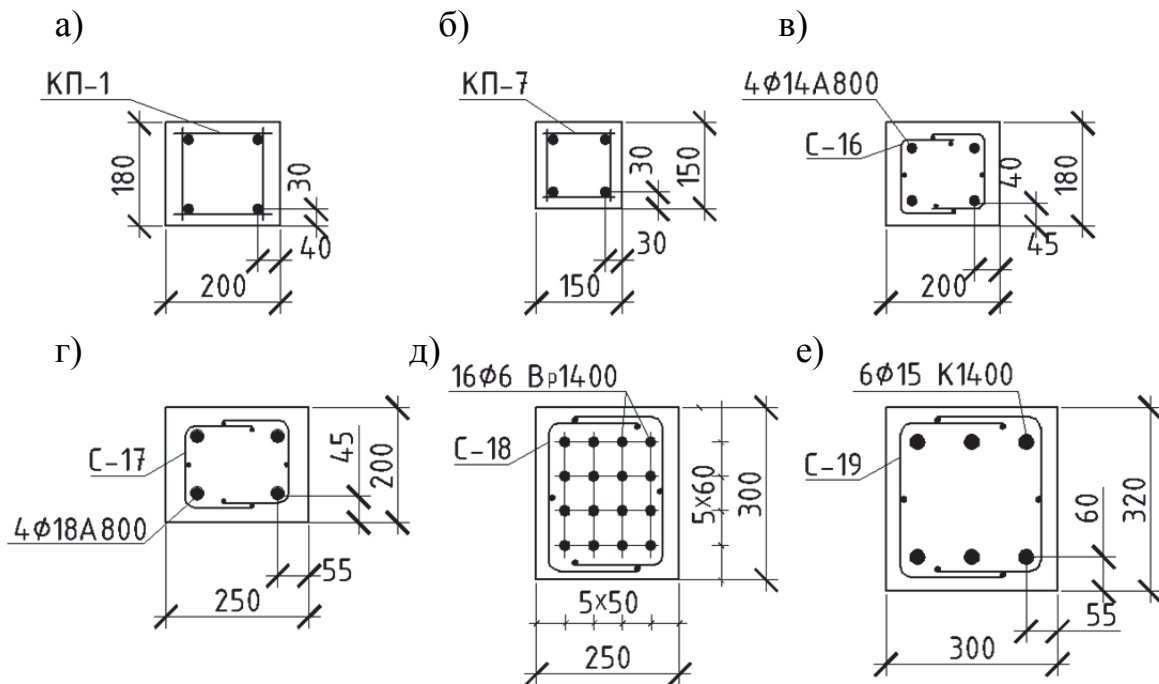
Примеры армирования сечений сегментной фермы пролетом 18 м:
